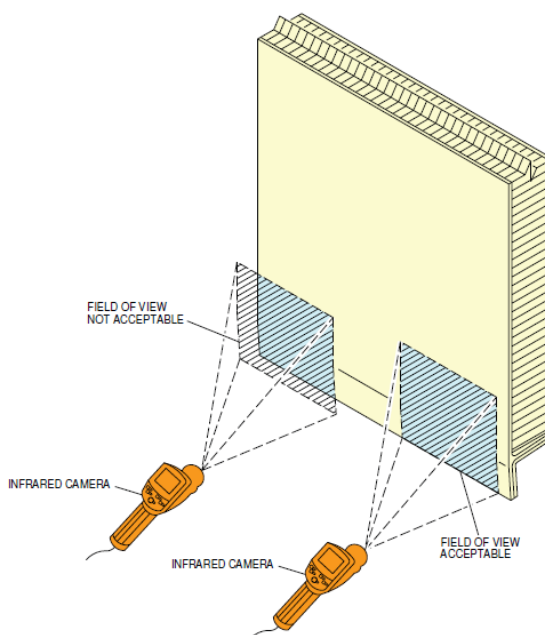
Schématické zobrazení průběhu zkoušky [5]
